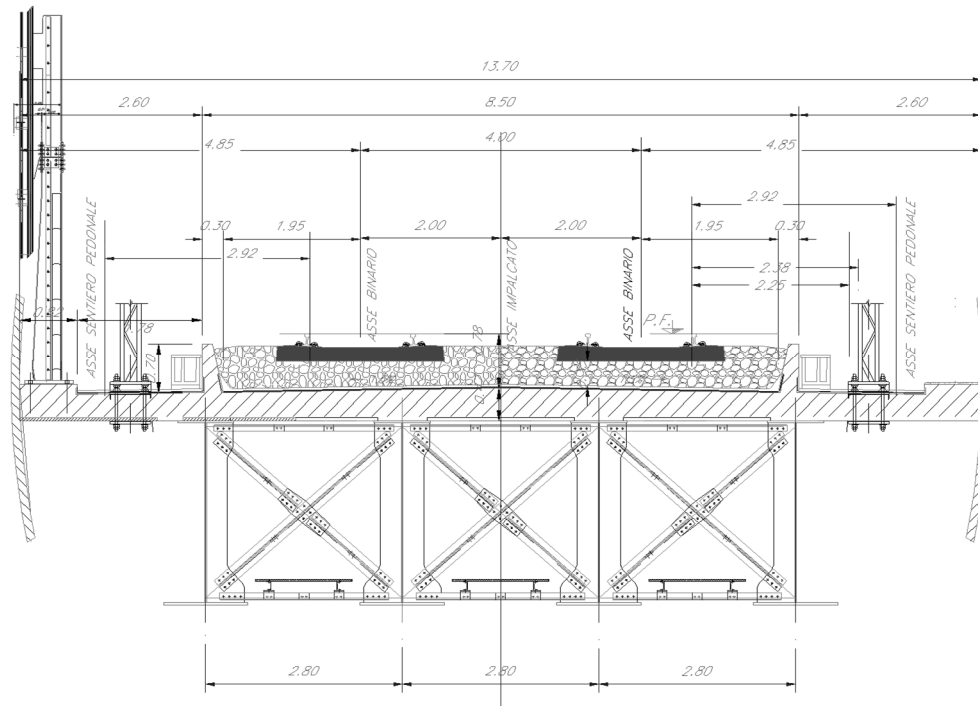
Sezione tipo in viadotto – Sezione mista acciaio-calcestruzzo DB
